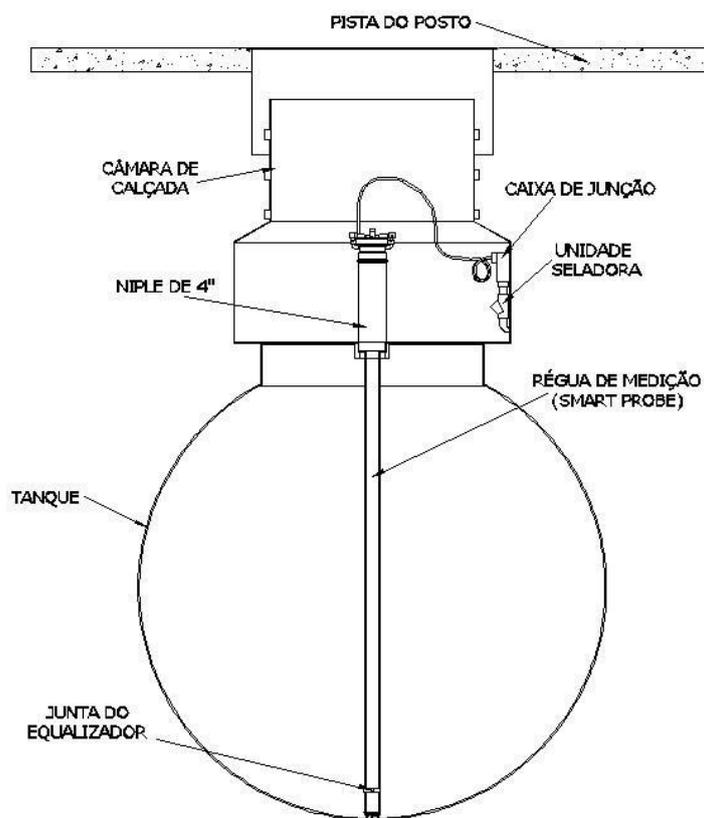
Detalhe de instalação do SmartProbe em um tanque
